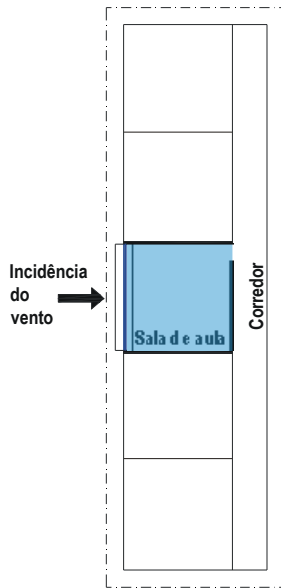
Planta baixa do modelo com o peitoril ventilado curvo
